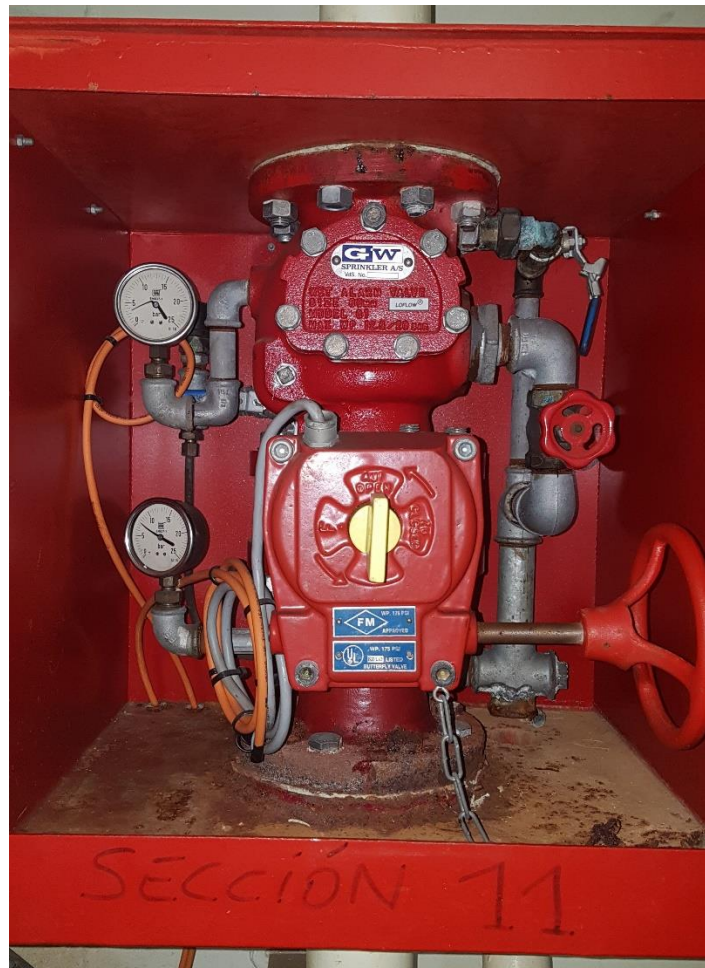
Sección de Sprinklers. Fuente Propia.
